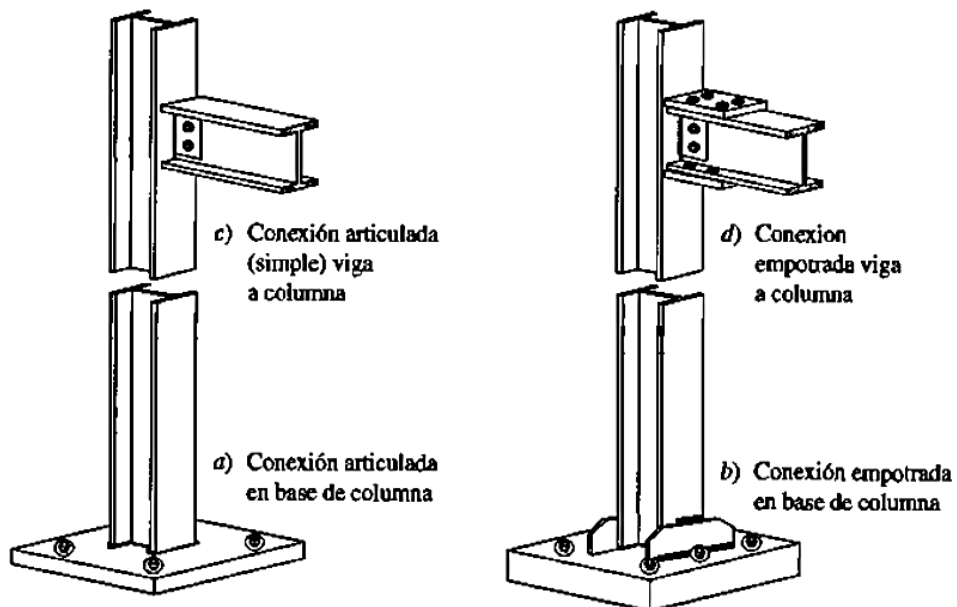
Conexión articulada y empotrada en la unión viga – columna y en la base de la columna
